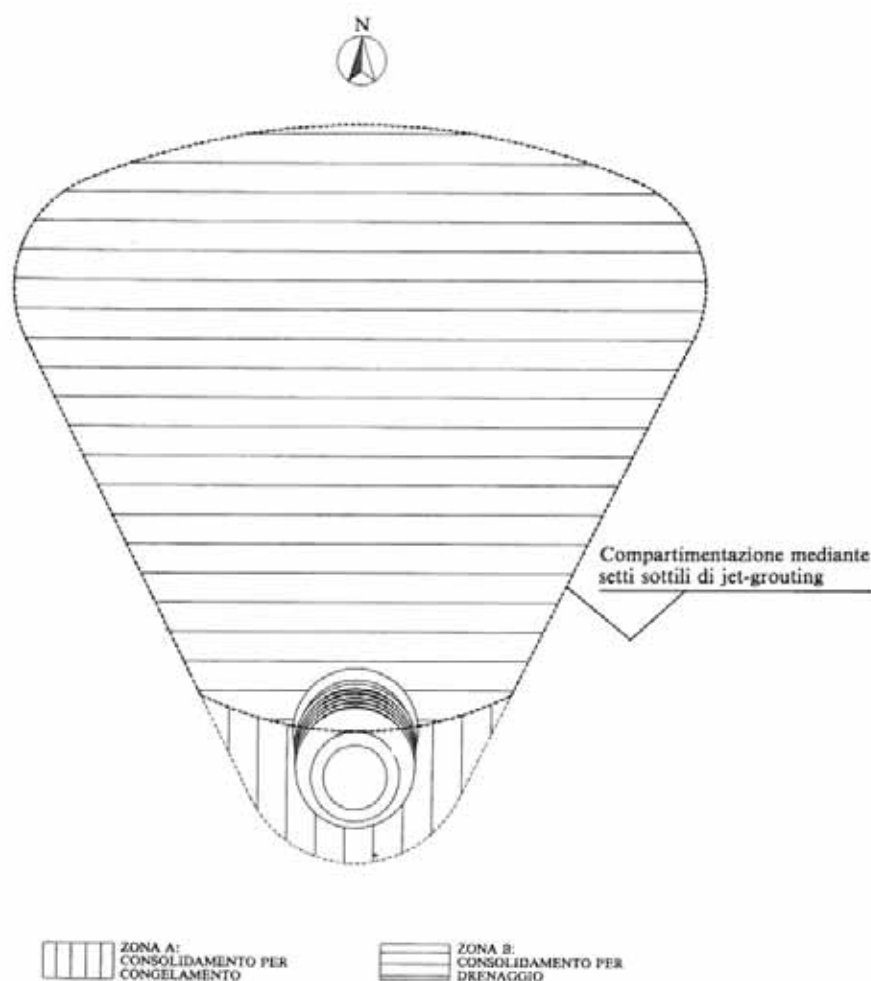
Schema planimetrico di stabilizzazione per compartimentazione del terreno e regimazione della falda.
